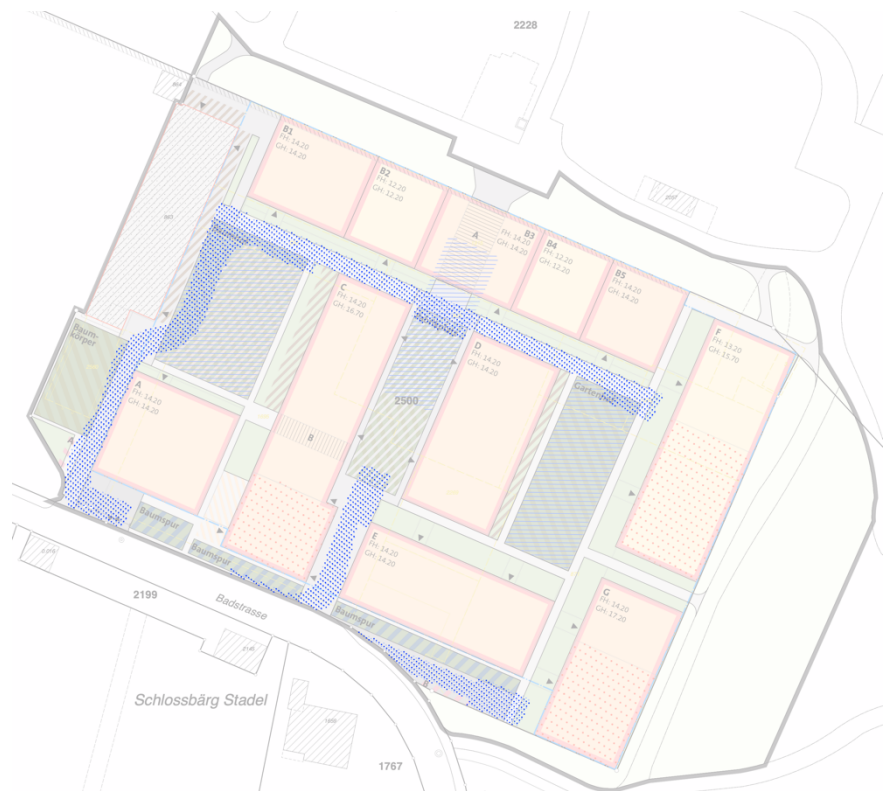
Notzufahrten mit Bewegungs- und Stellflächen
